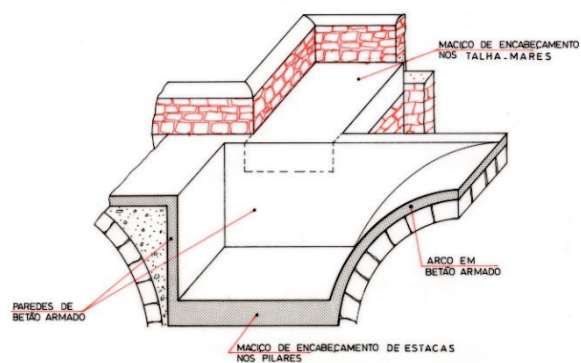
Pormenor da estrutura interior de reforço da ponte, em betão armado
